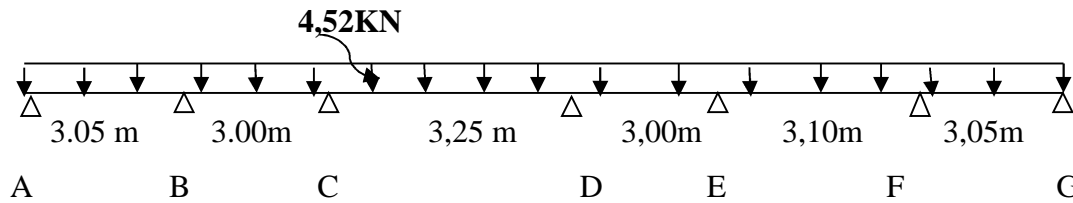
Schéma statique de la poutre continue reposant sur sept appuis à l'ELS.
